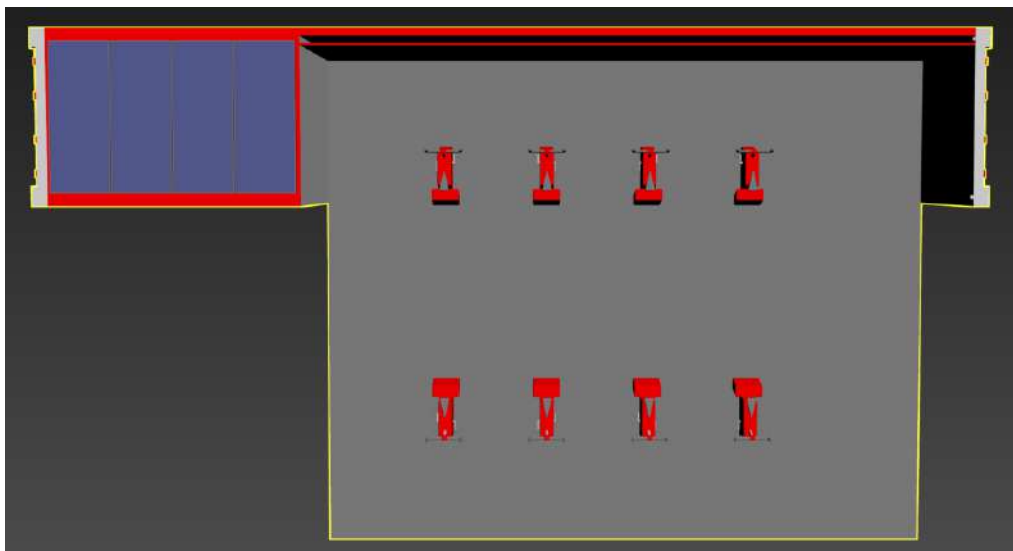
Render container abierto con todos los elementos planta “Fuente: Elaboración propia”
